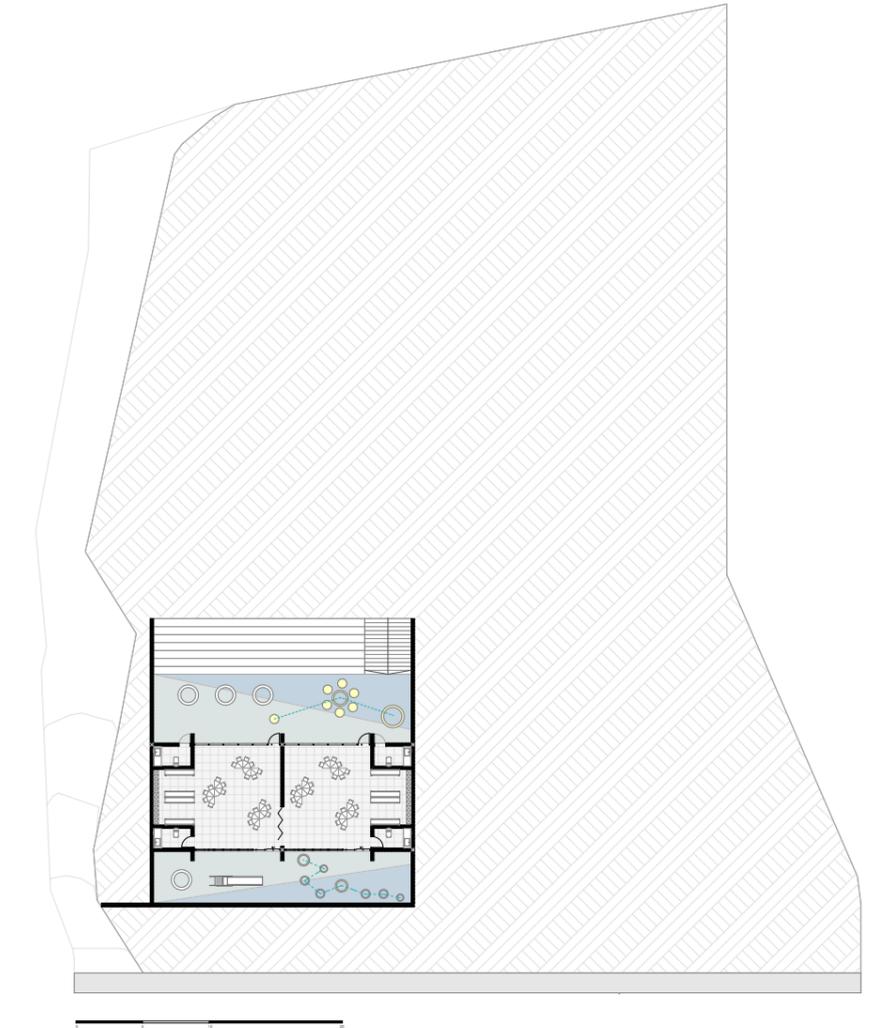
Planta subsuelo. Fuente: Elaboración propia.
